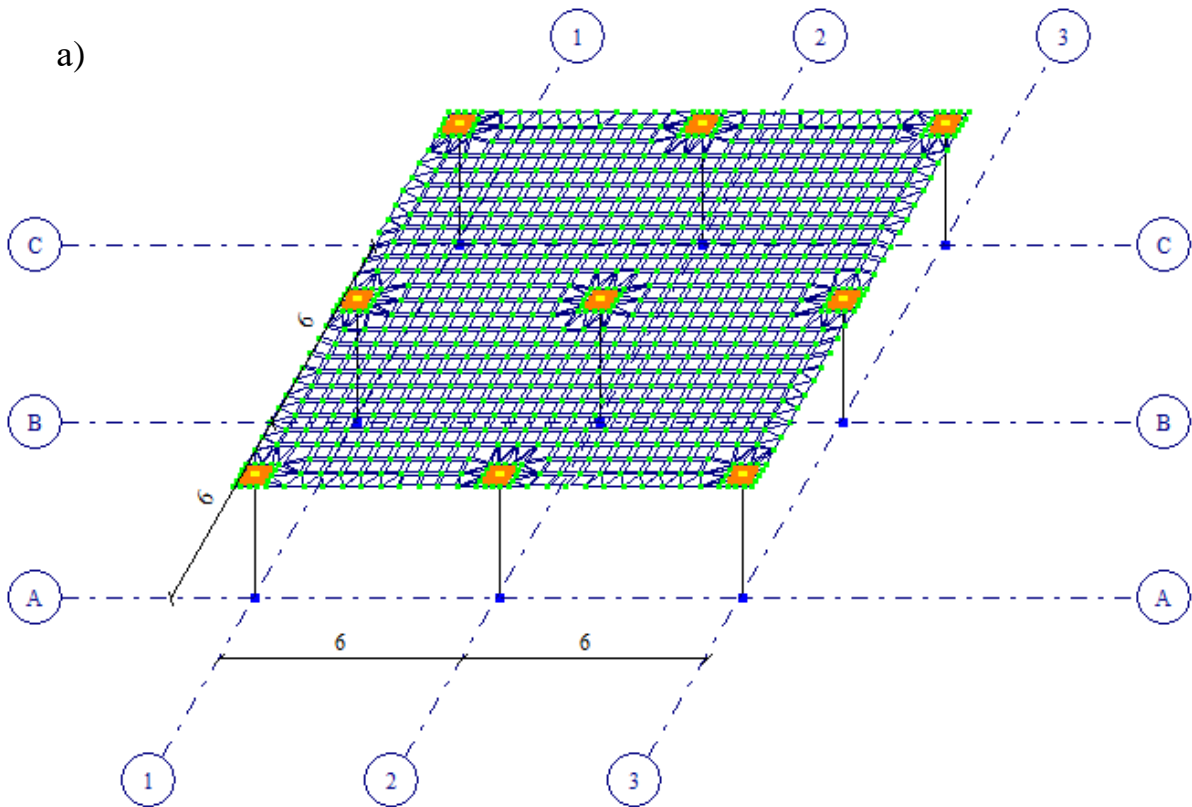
Скінчено-елементна схема плити залізобетонного перекриття, що досліджується, в осях 1-3 та А-В
